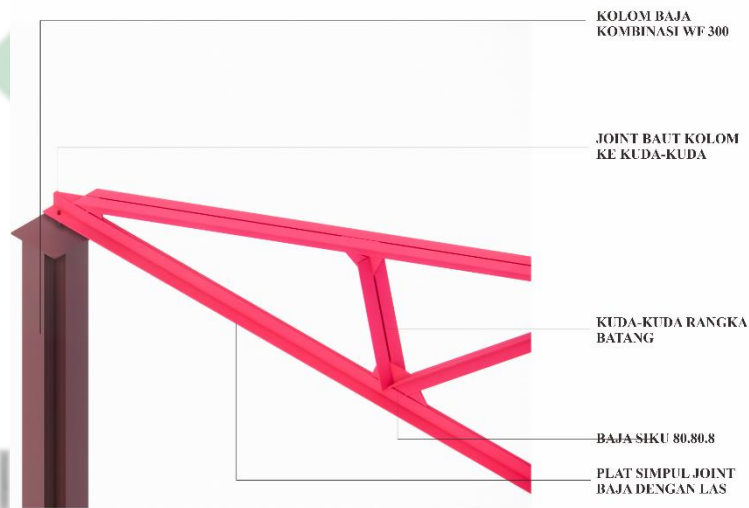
Isometri Pemasangan Rangka Atap Baru ke Kolom Baja Eksisting
